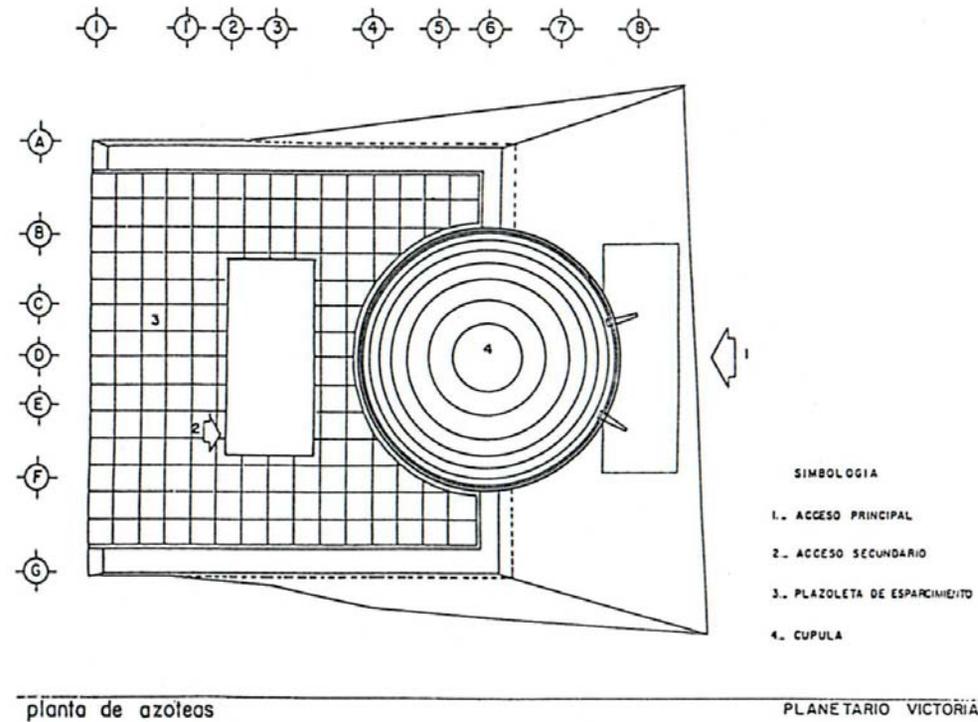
Planta de azoteas, planetario de Ciudad Victoria.
